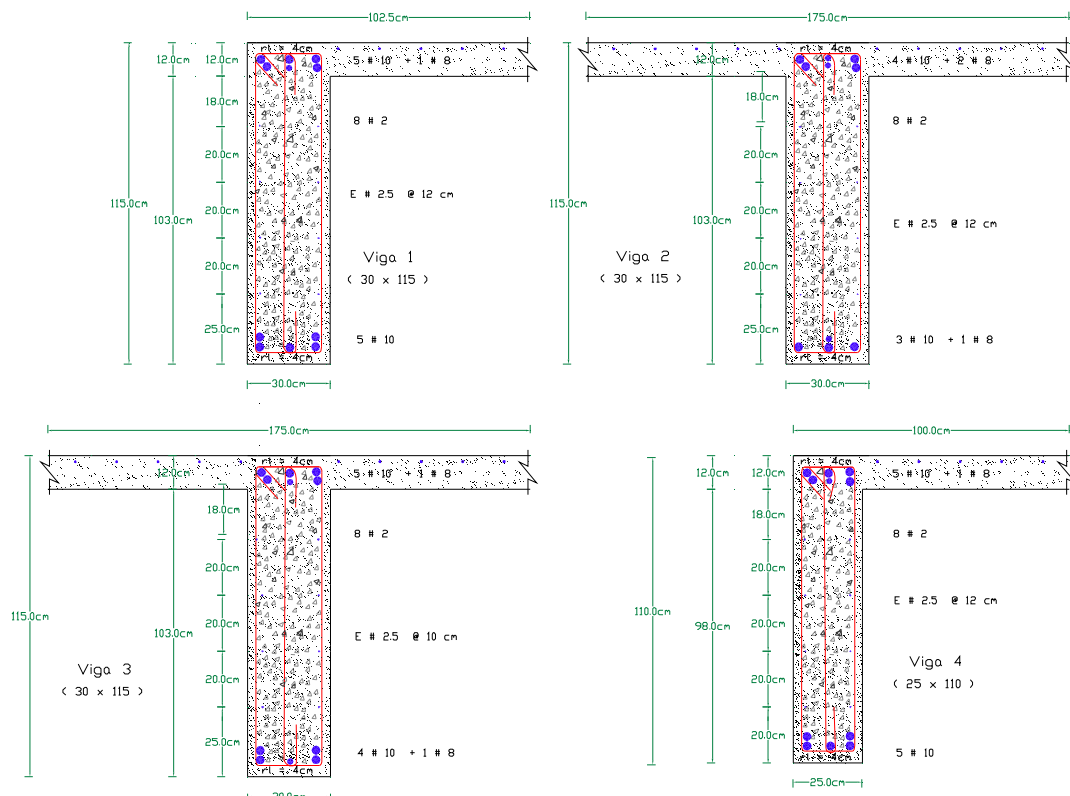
Dimensiones y armado de vigas, edificio III_9
